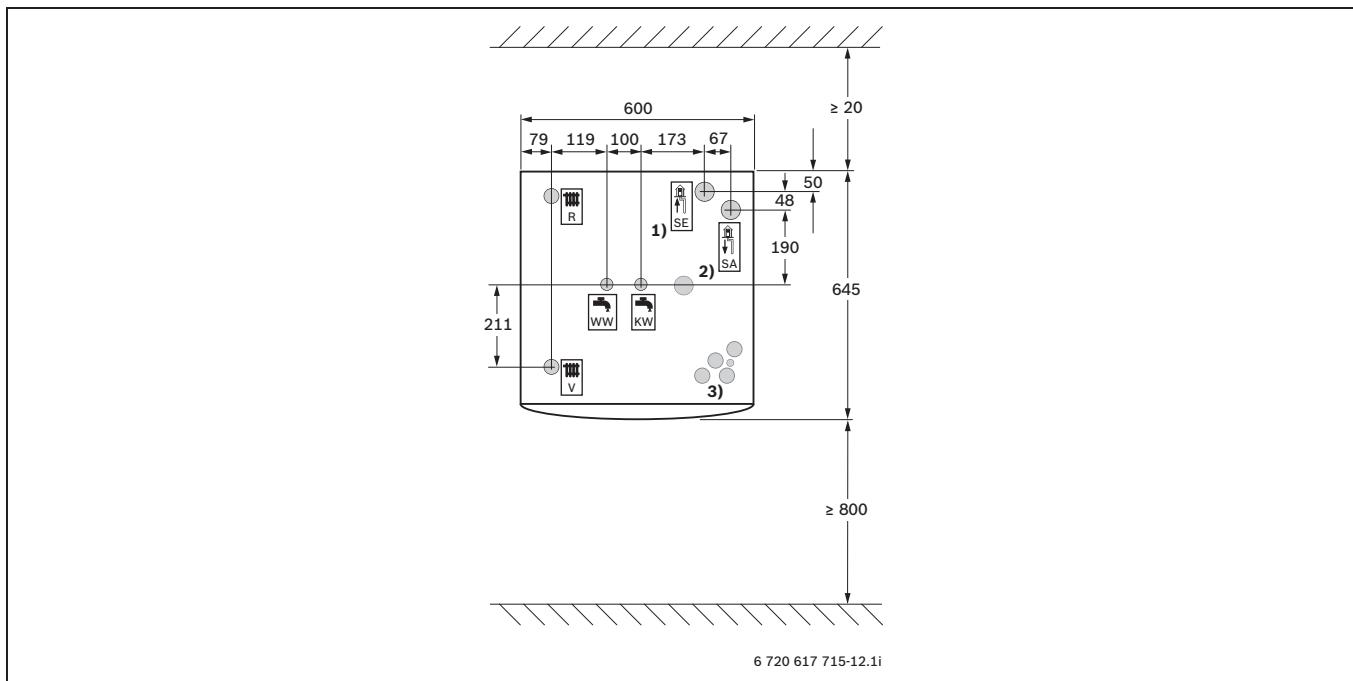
Abmessungen der Wärmepumpen STM 60 ... STM 110 (Maße in mm)
